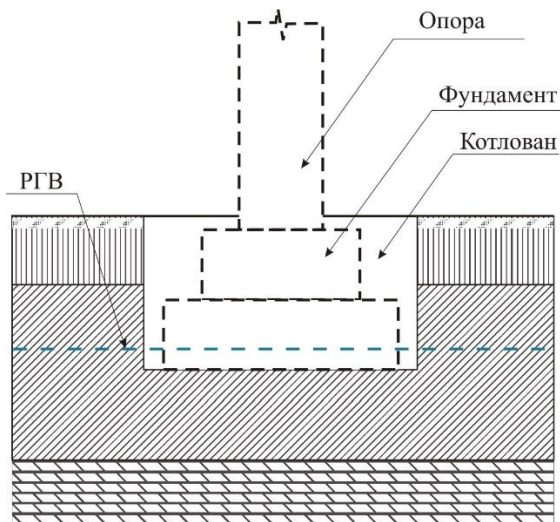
Схема котловану з рівнем ґрунтових вод вище дна котловану
